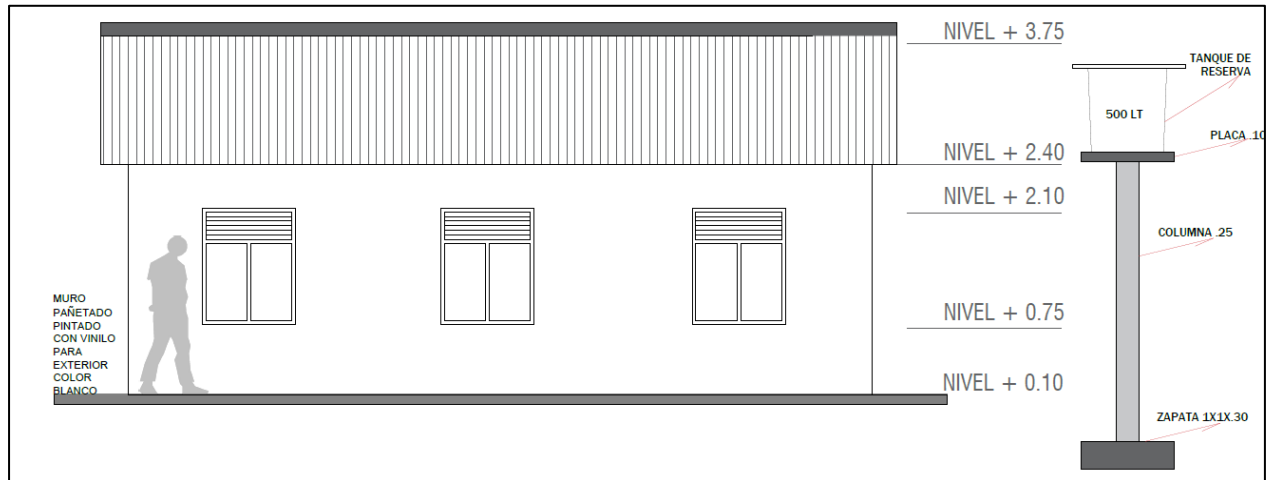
Fachada posterior. Fuente: Autores, 2024.
